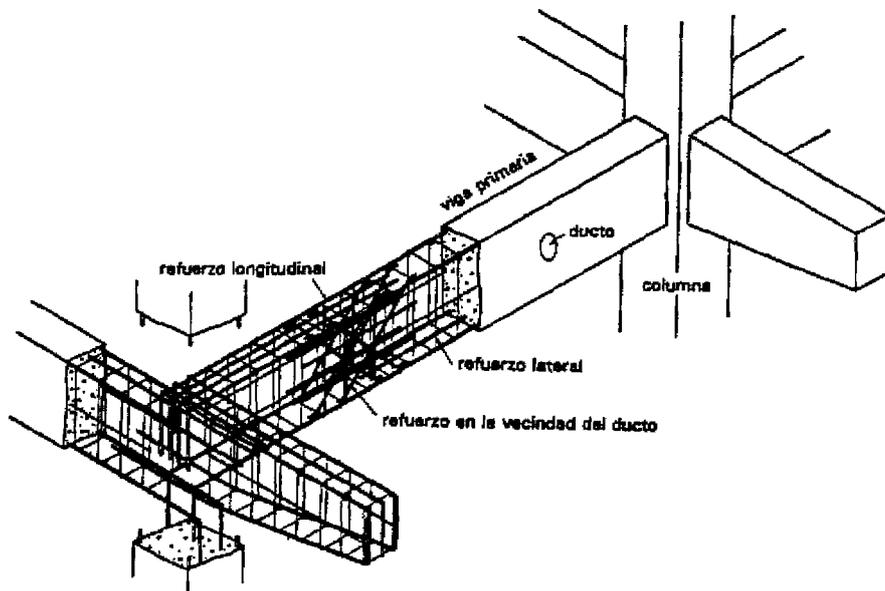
Detalle de refuerzo para ductos en el alma de viga
